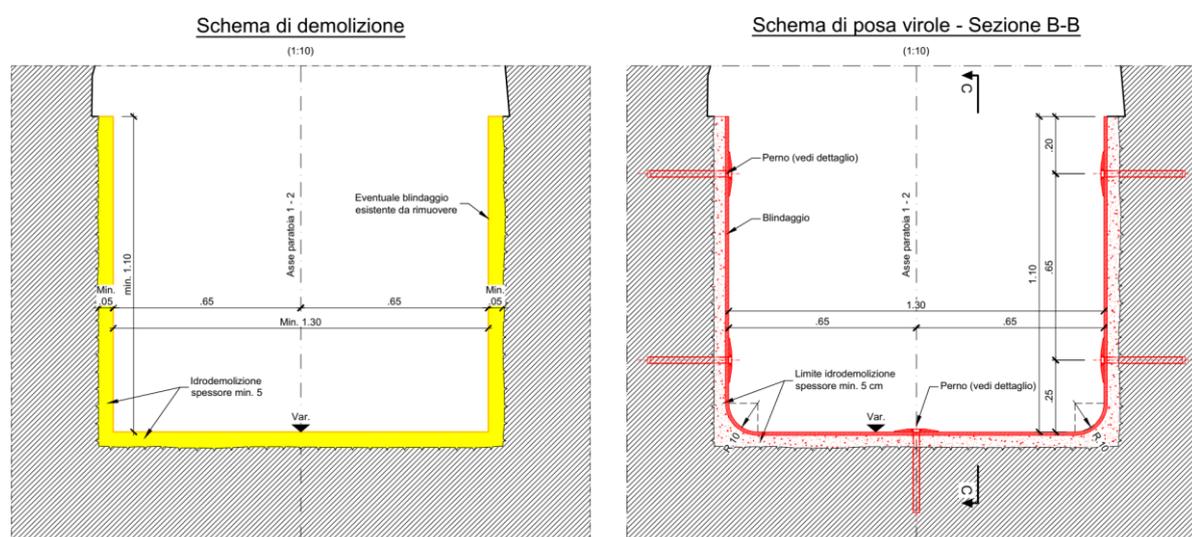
Sezioni tipo dell'intervento di risanamento dello scarico di fondo esistente
